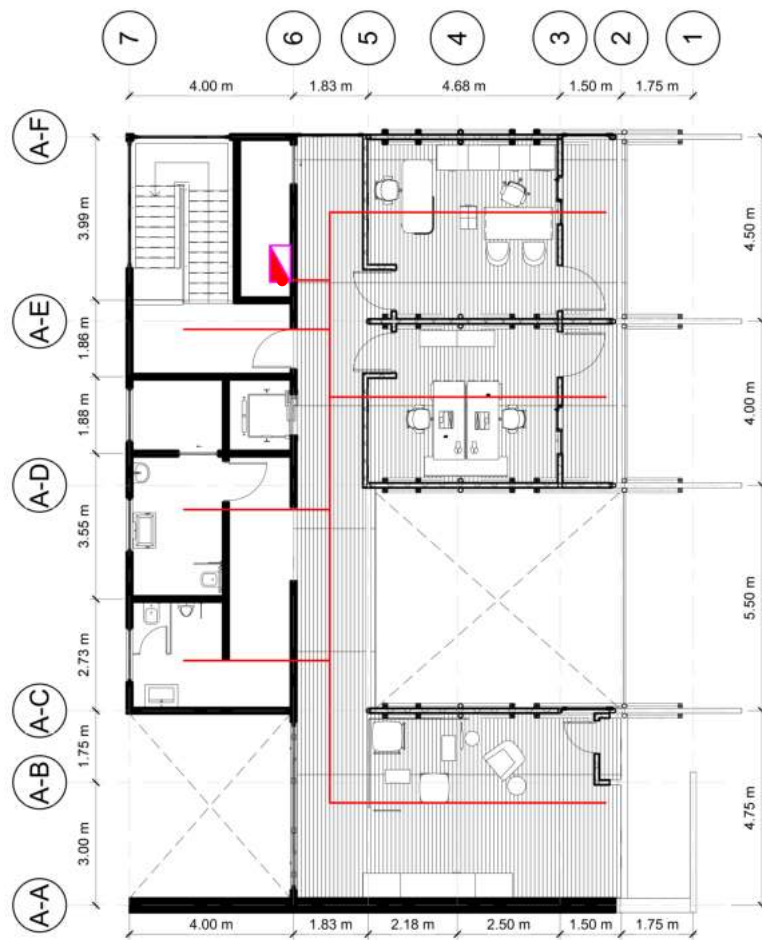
PLANTA ELECTRICA NIVEL +4.00 SIN ESCALA
